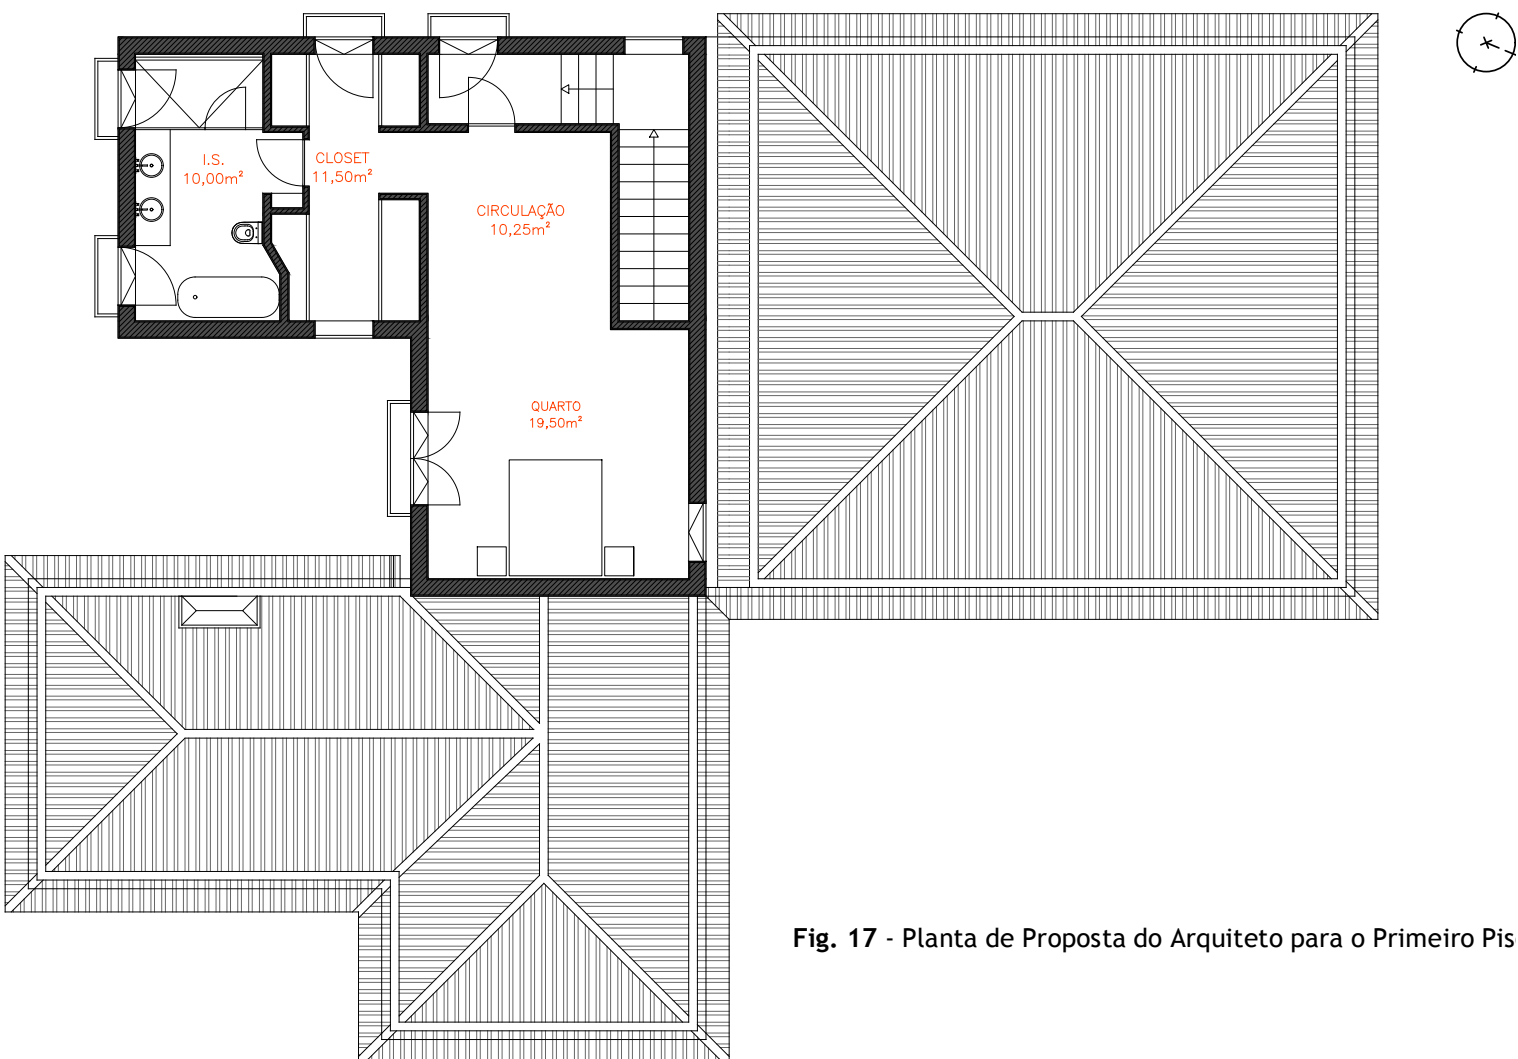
Planta de Proposta do Arquiteto para o Primeiro Pis
